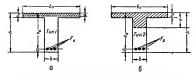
34. Тавровые сечения изгибаемых элементов: a — нейтральная ось располагается в пределах полки; δ — нейтральная ось пересекает ребро.
